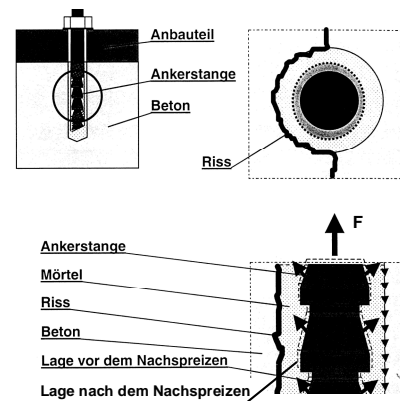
Störung des Verbundes zwischen Mörtel und Beton durch Riss im Ankergrund und Übertragung der Zuglast bei Verbund-Spreizdübeln (Eligehausen/Mallée (2000))
